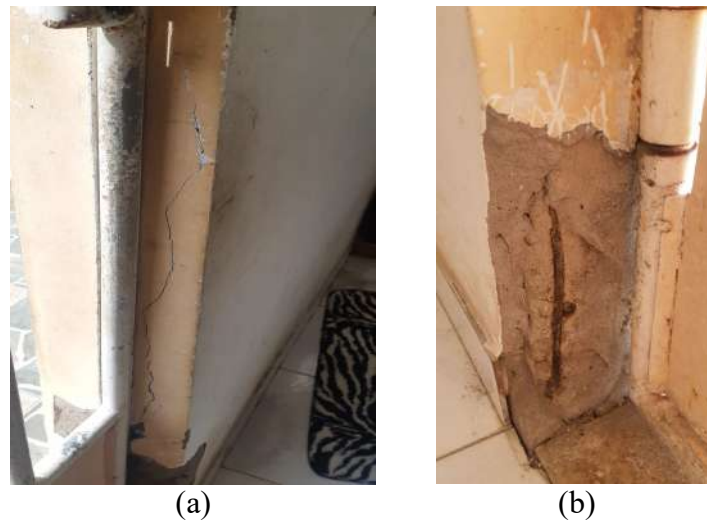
Fissura devido à expansão da armadura (a) e armadura exposta em processo de corrosão (b).
